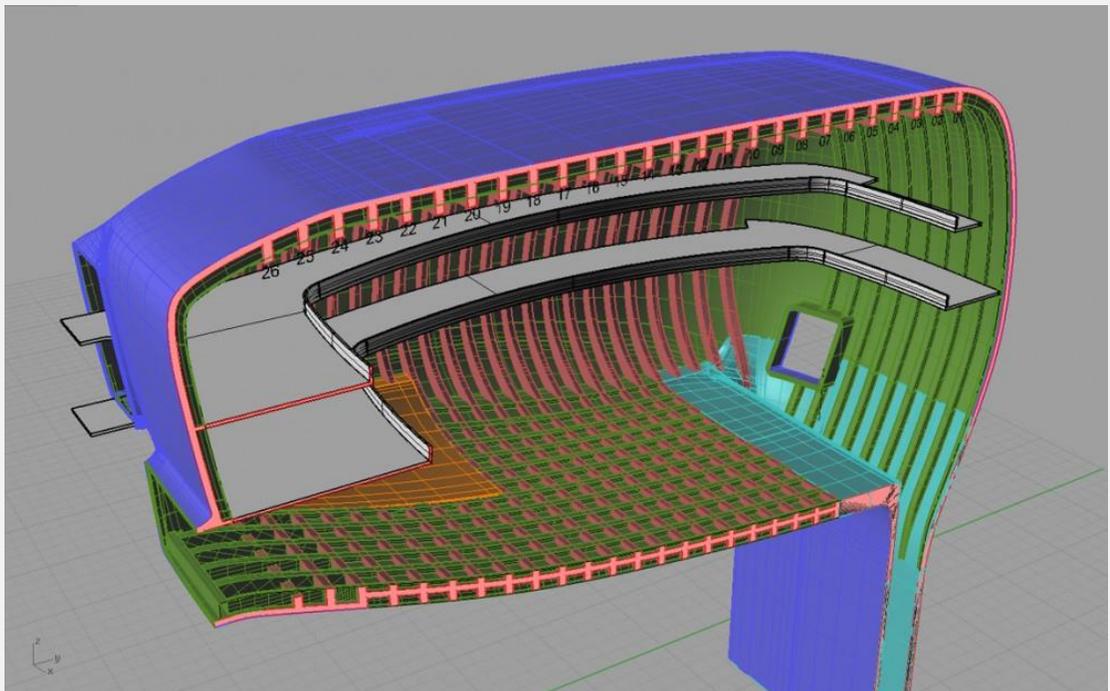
Sección longitudinal de la “Ballena Azul” – Centro Cultural Kirchner
